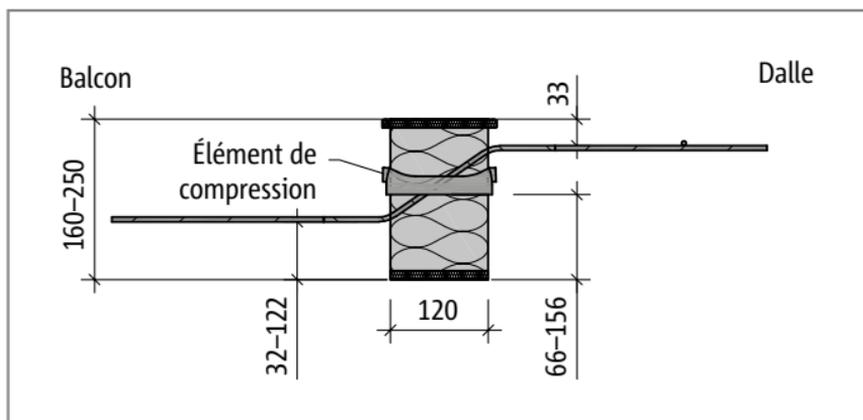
Schöck Isokorb® XT type Q-E-V1
